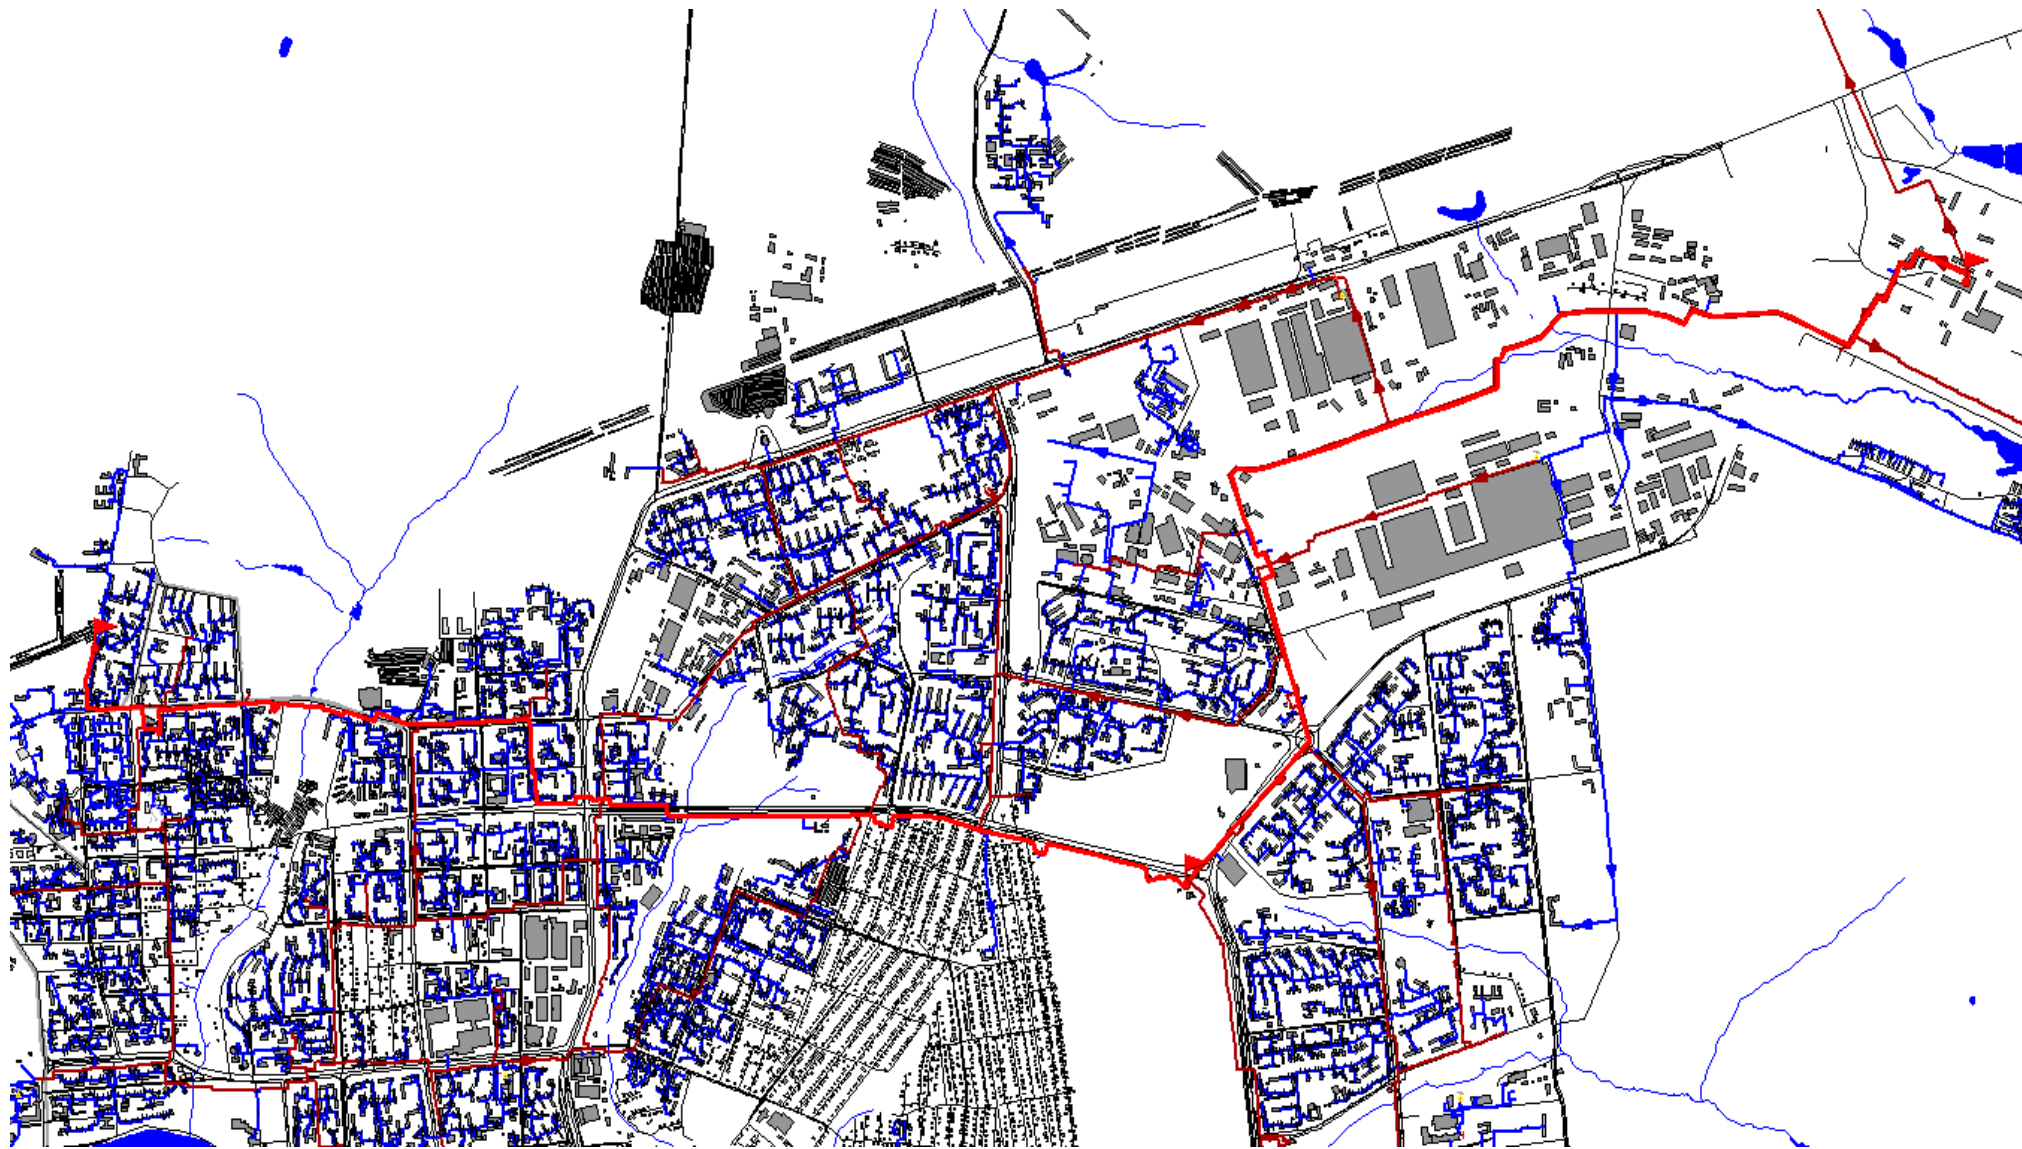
Расчетная схема участка тепловой сети от Ижевской ТЭЦ-2 до ТК-2
